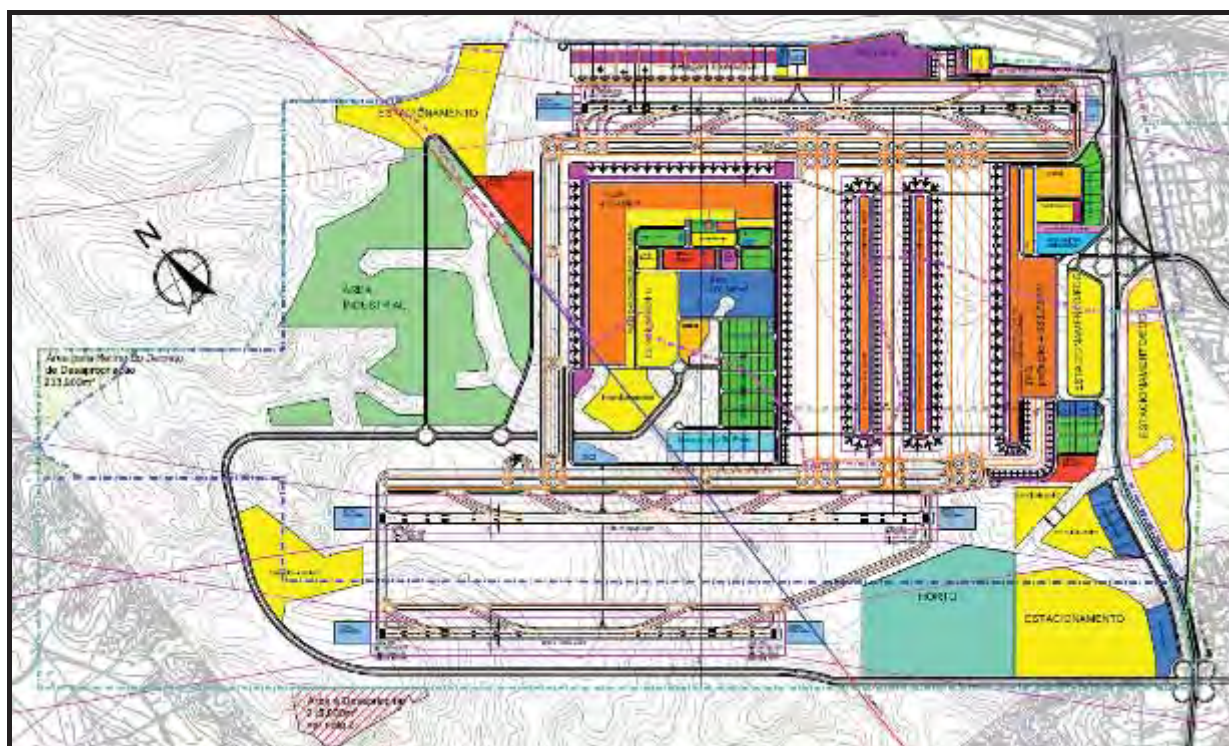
Configuração final em 2025 (PLANWAY, 2007).
